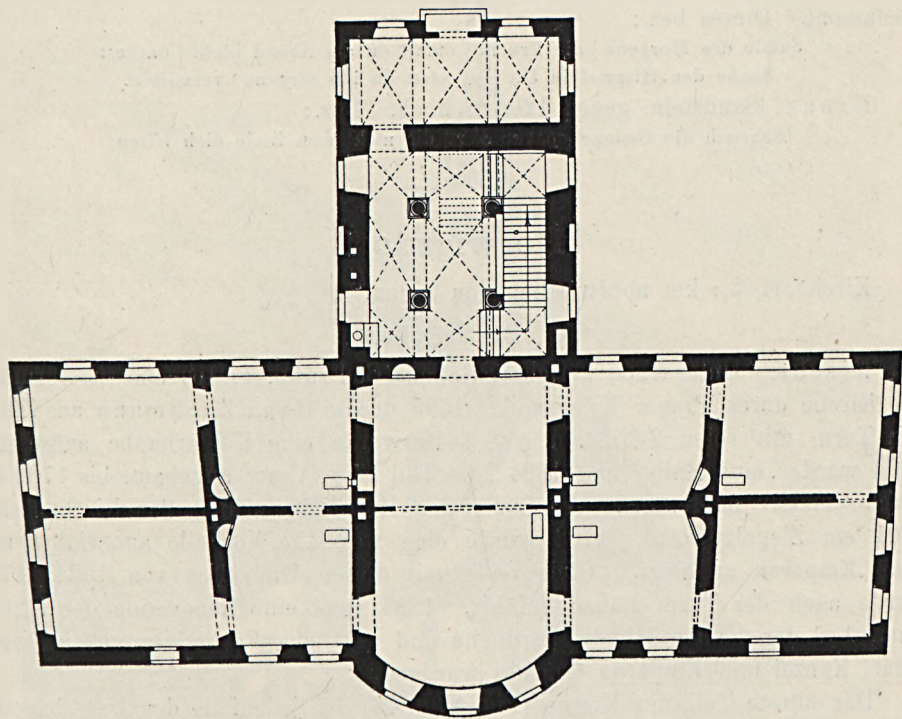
Hainewalde, Schloß, Grundriß des Obergeschoßes.
